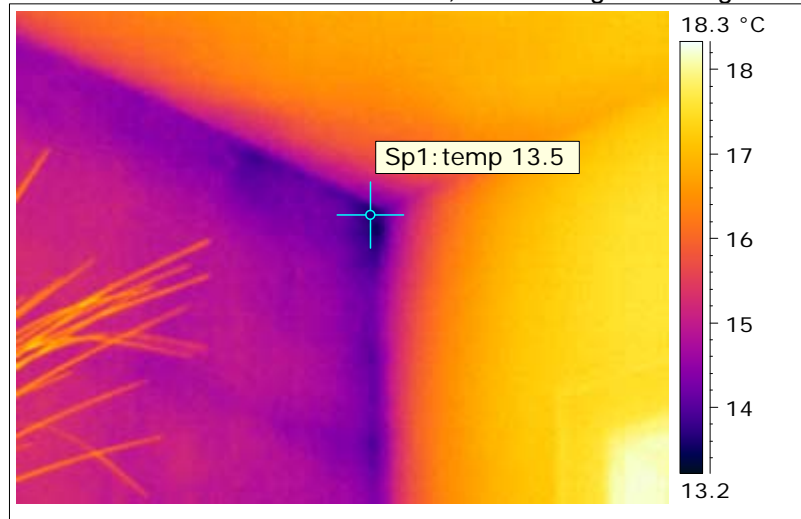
Innen: DG Zimmer zu Straße, Dachschräge Richtung Flur
